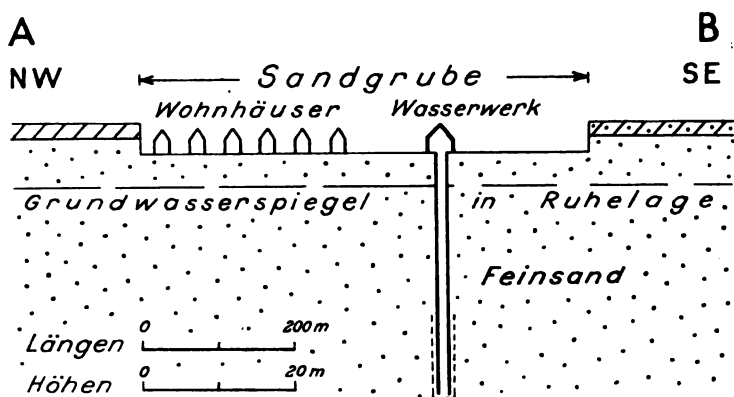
Stark gefährdete Lage eines Wasserwerkes in einer bebauten Sandgrube
